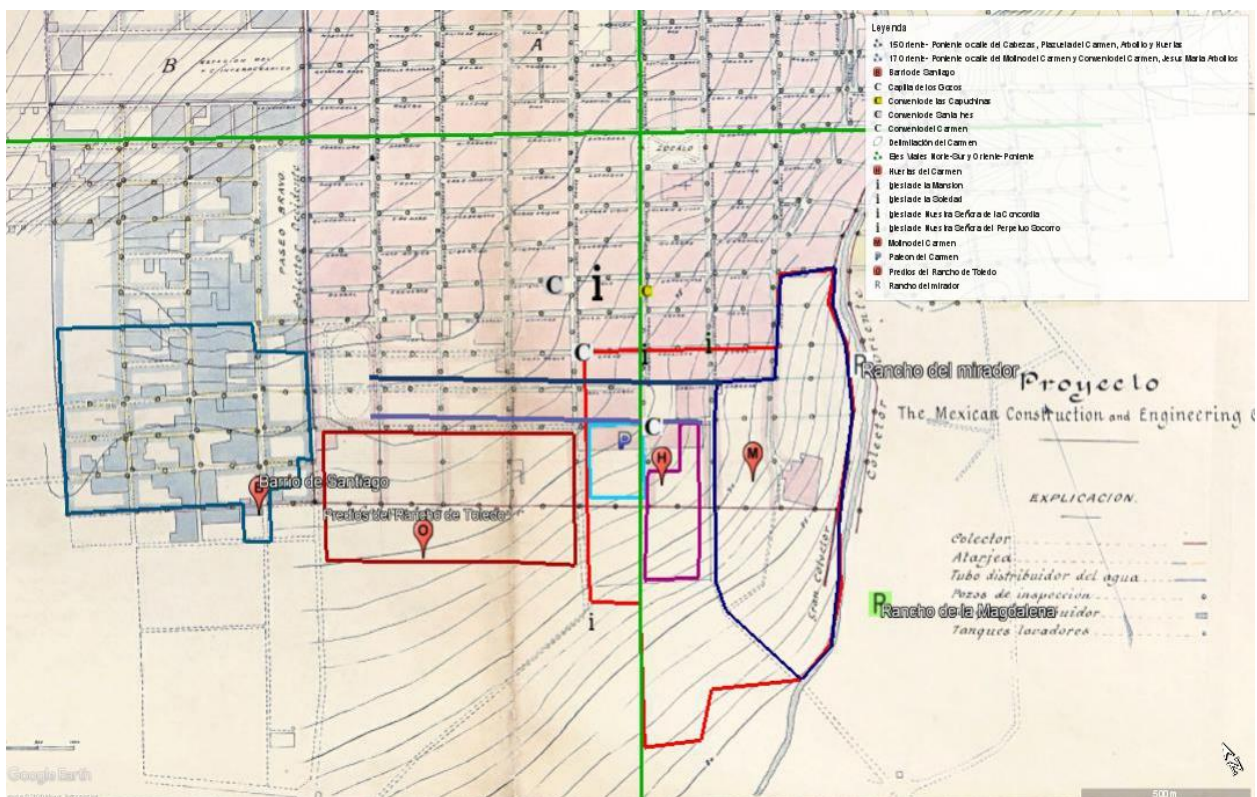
Plano acotado de la ciudad de Puebla, proyectando el sistema de saneamiento propuesto por la Compañía Mexicana de Construcciones y Obras de Ingeniería S.A. 1906. (Vélez Pliego 2016:47)
